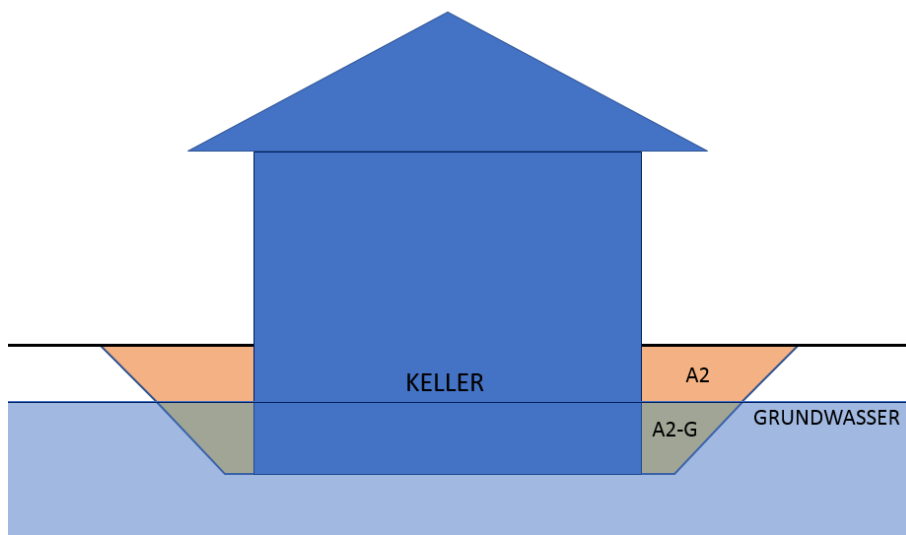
Baugrubenhinterfüllung mit vorhandenem Grundwasserspiegel
